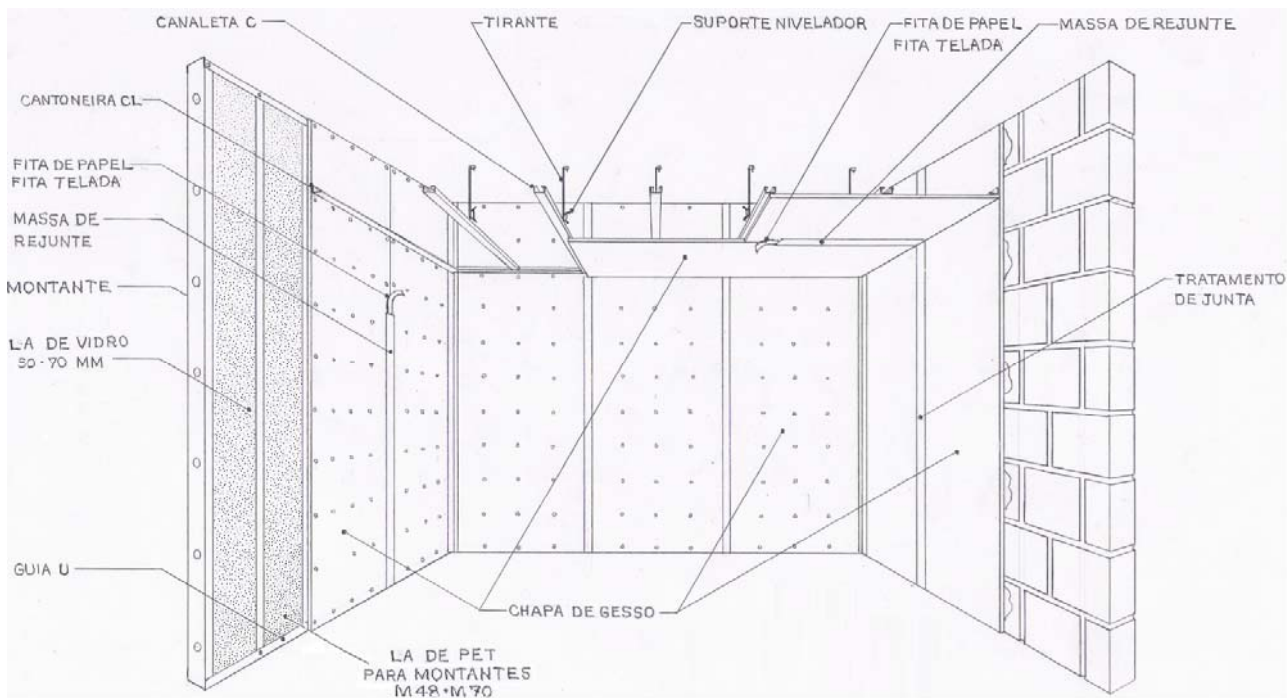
Ilustração do sistema construtivo em chapas de gesso para *drywall
